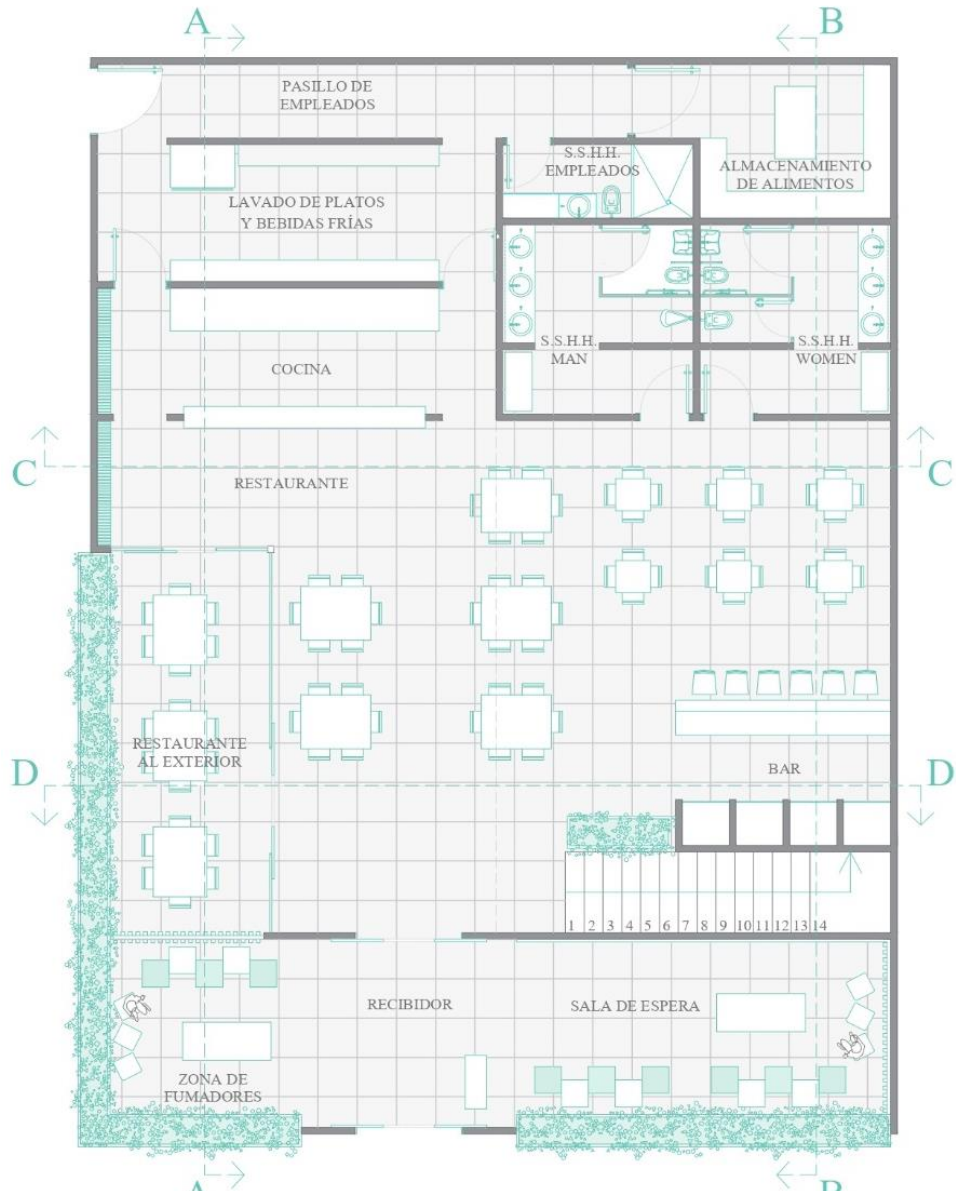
Plano de planta baja del restaurante. Elaborado por el autor
